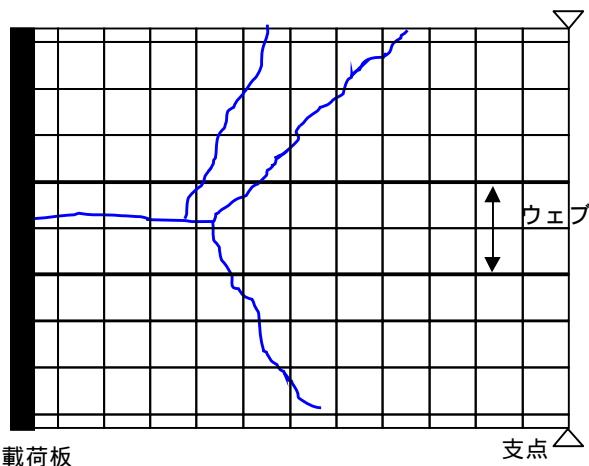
No.4 フランジ上面ひび割れ図 (荷重 207kN時)
